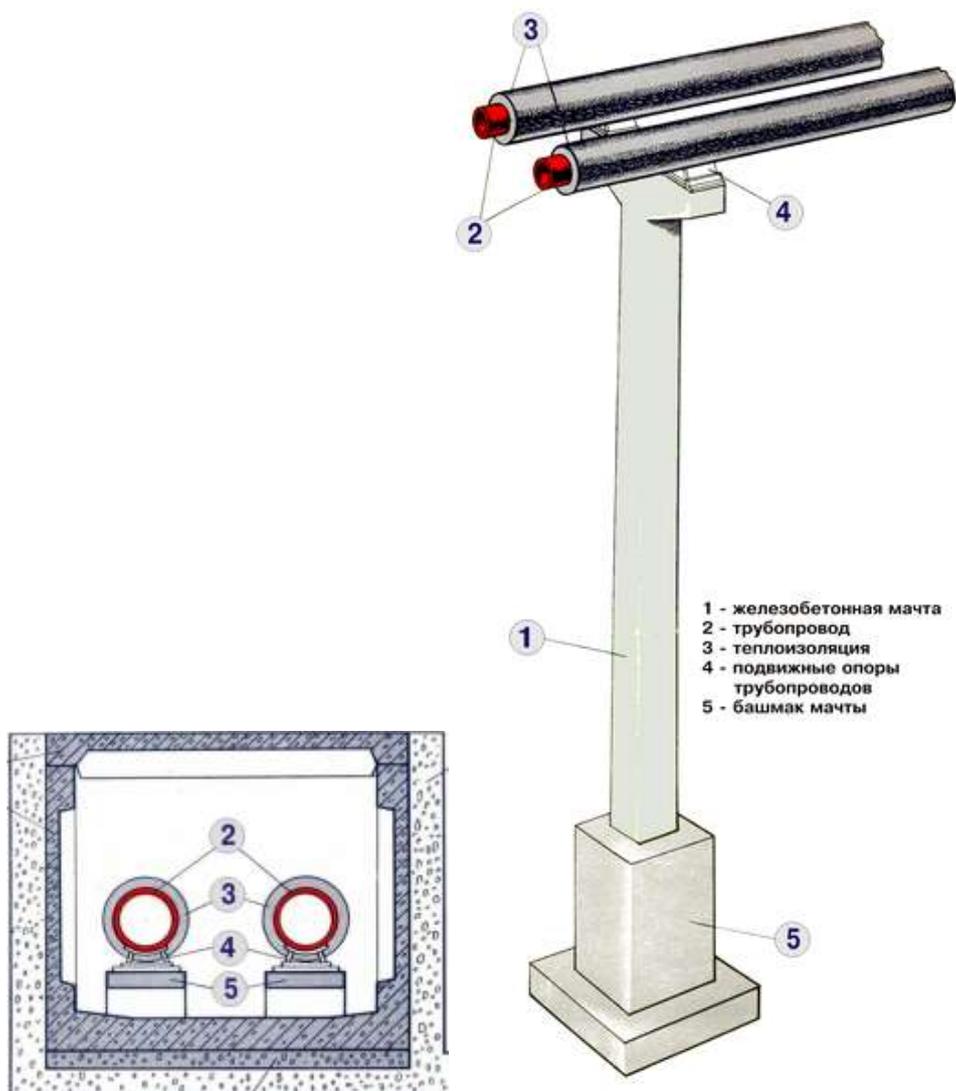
Поперечное сечение тепловой сети в канале, надземная прокладка трассы на эстакадах
